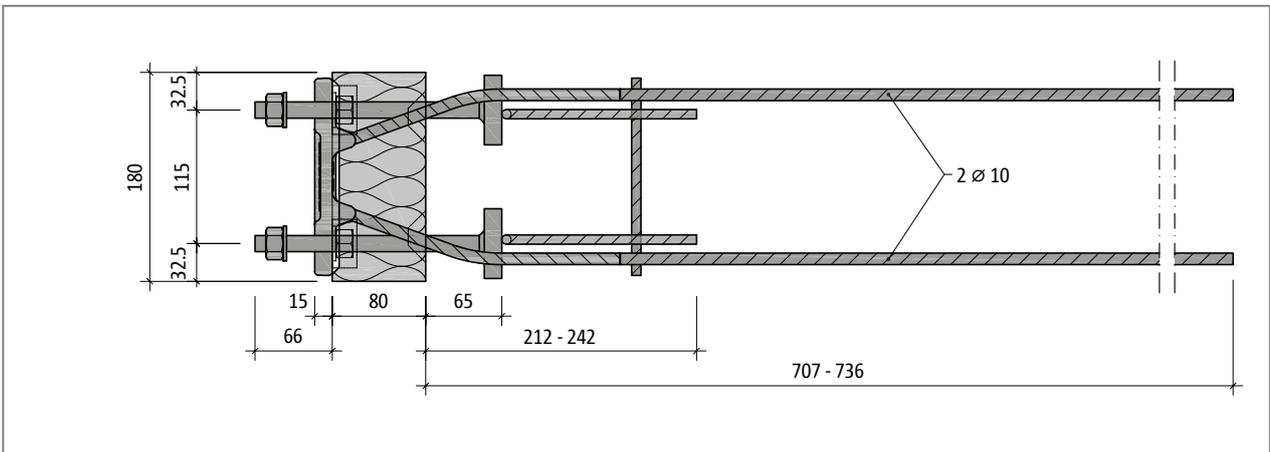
Schöck Isokorb® T type SQ-V2: Plan view
